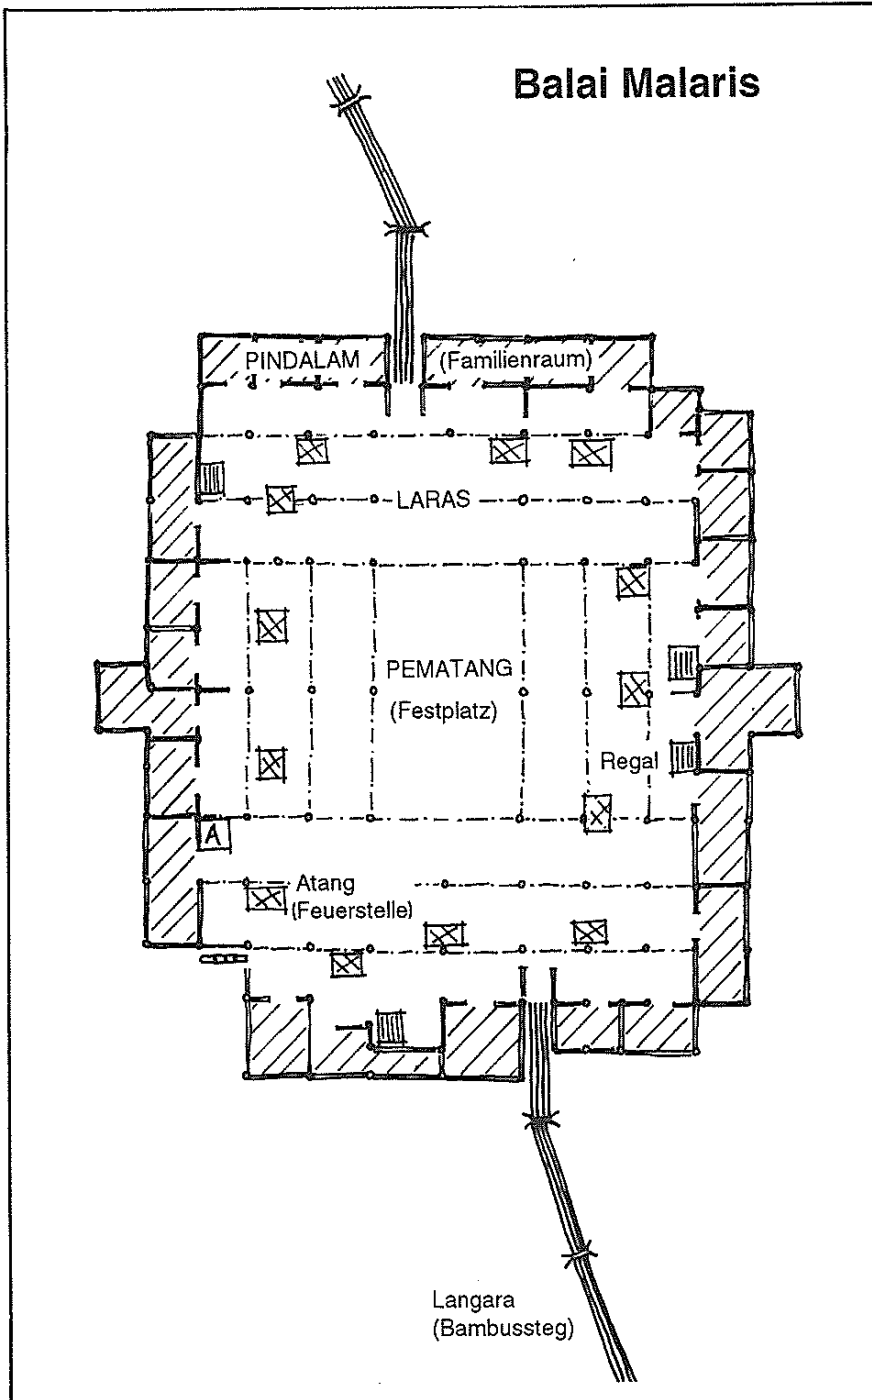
Grundriss des balai (Halle) der Orang Bukit in Malaris/ Südostborneo
